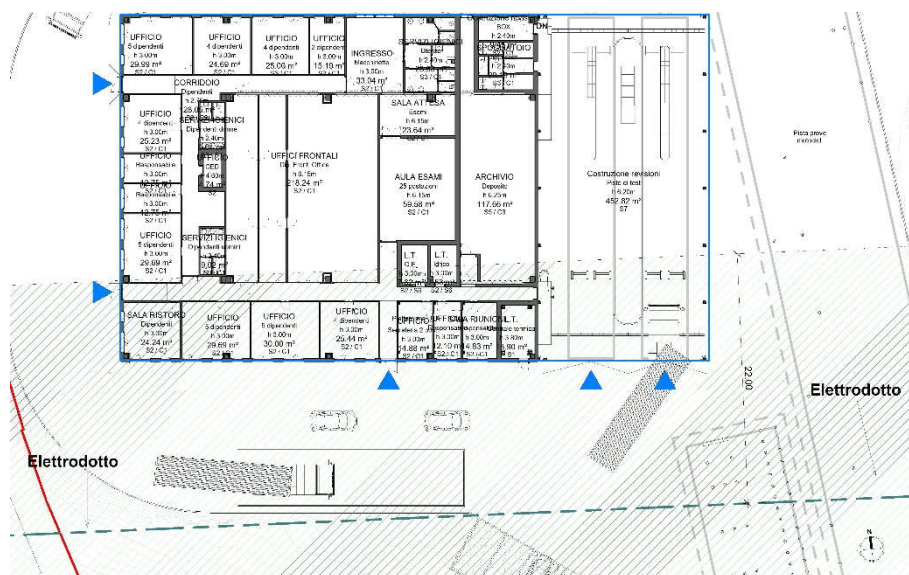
Pianta dell'edificio – Proiezione a terra della fascia di rispetto dell'elettrodotto – destinazione d'uso locali interessati
